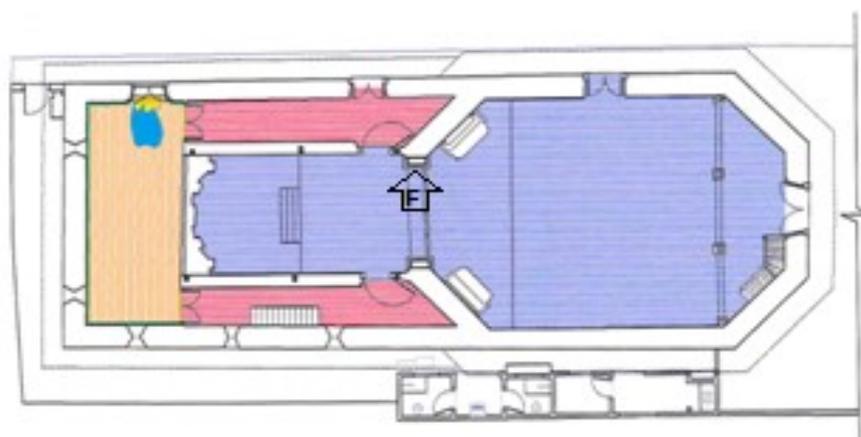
Vista F - Coluna e base do lado direito do arco do cruzeiro – Planta pavimento inferior Capela Sem escala.
